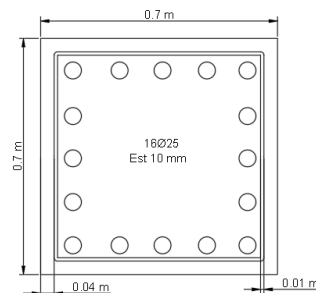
Detalle de vigas secundarias 8 Pisos
